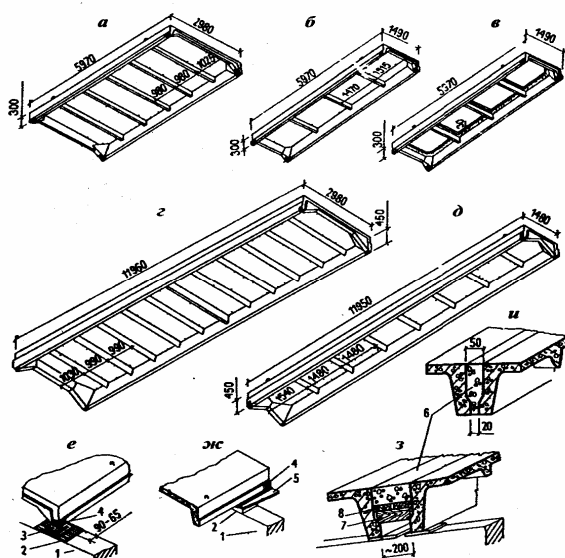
Железобетонные плиты покрытия (вид снизу).
